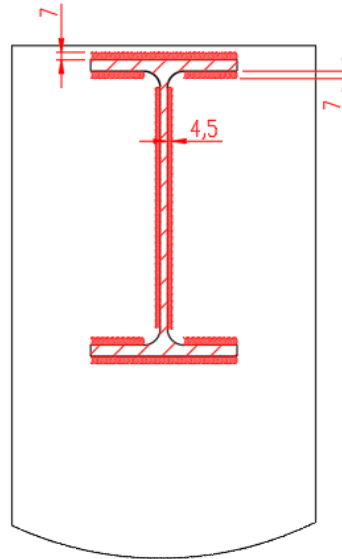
Unión viga IPE-270 - pilar HEB-280.
